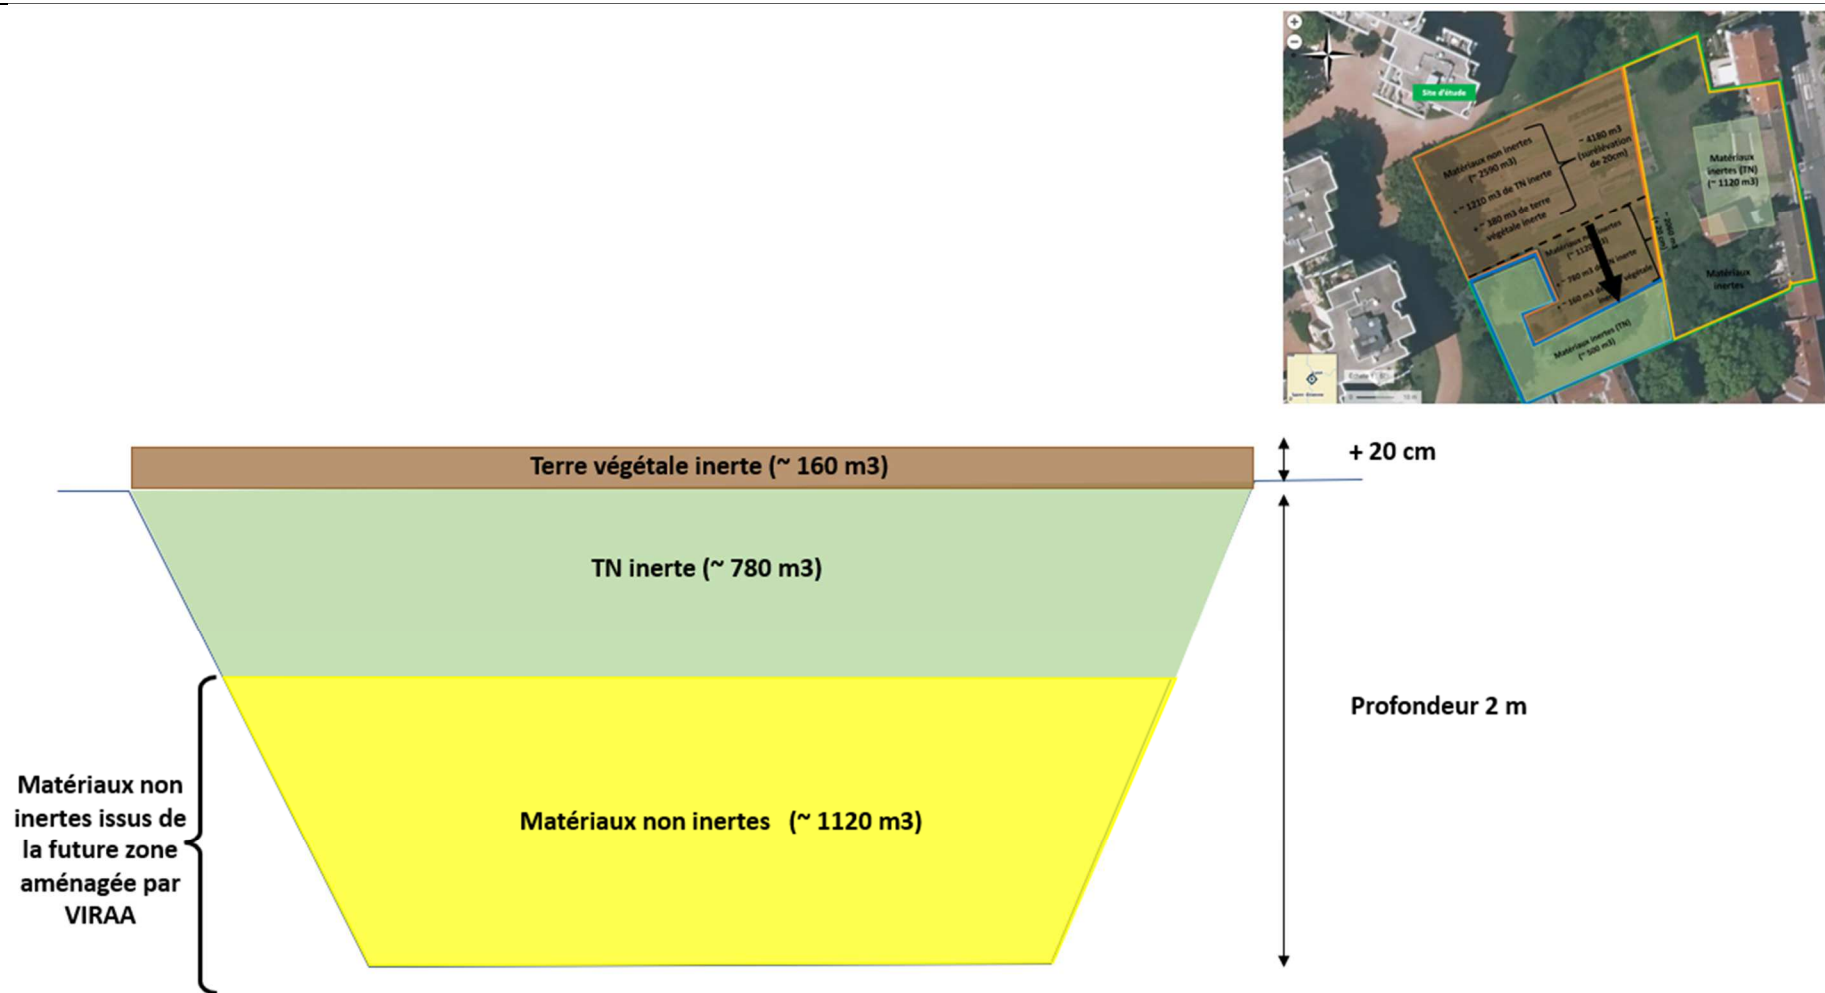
Coupe transversale de la zone d'emprunt (2/2)
